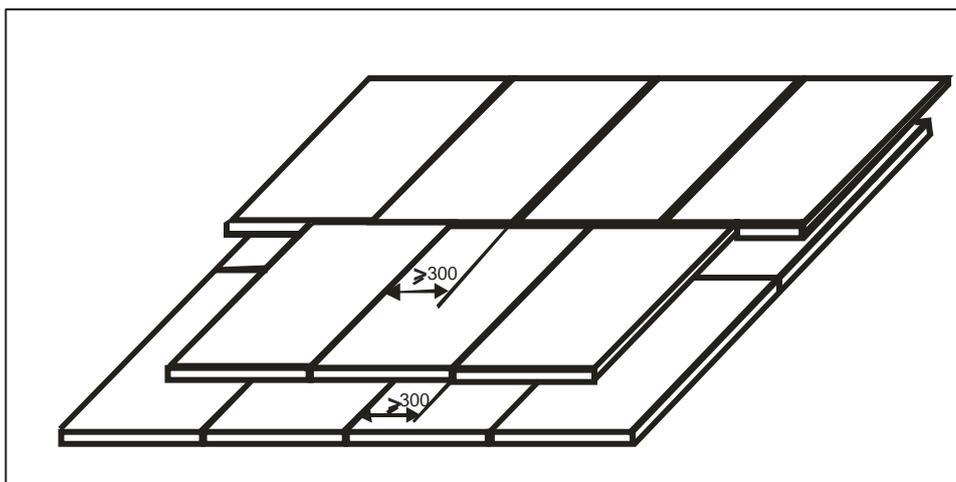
Схема укладки тепло-звукоизолирующих пенополистирольных плит
